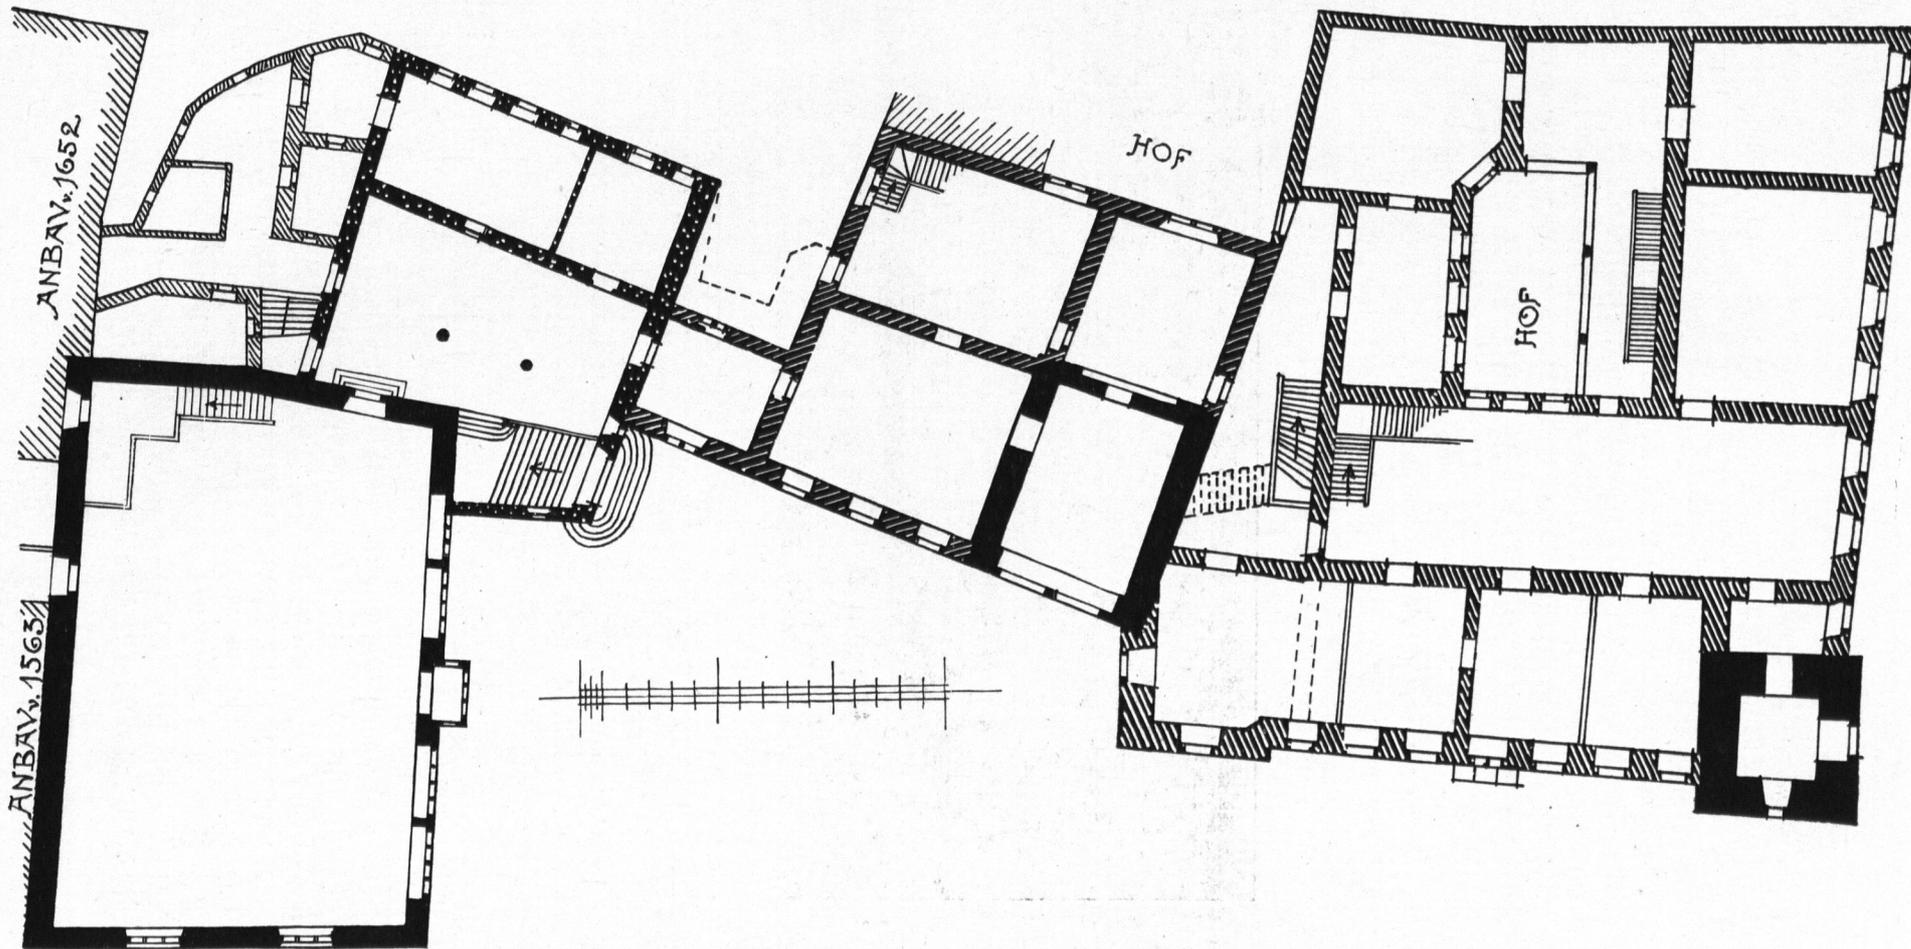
Rathaus zu Regensburg. Grundriß des ersten Stockwerks. Nach einer Aufnahme des Stadtbauamts.
